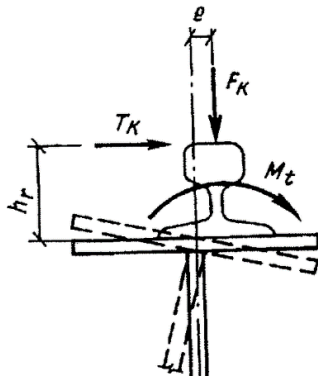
Передача усилий от кранового рельса на верхний пояс подкрановой балки
